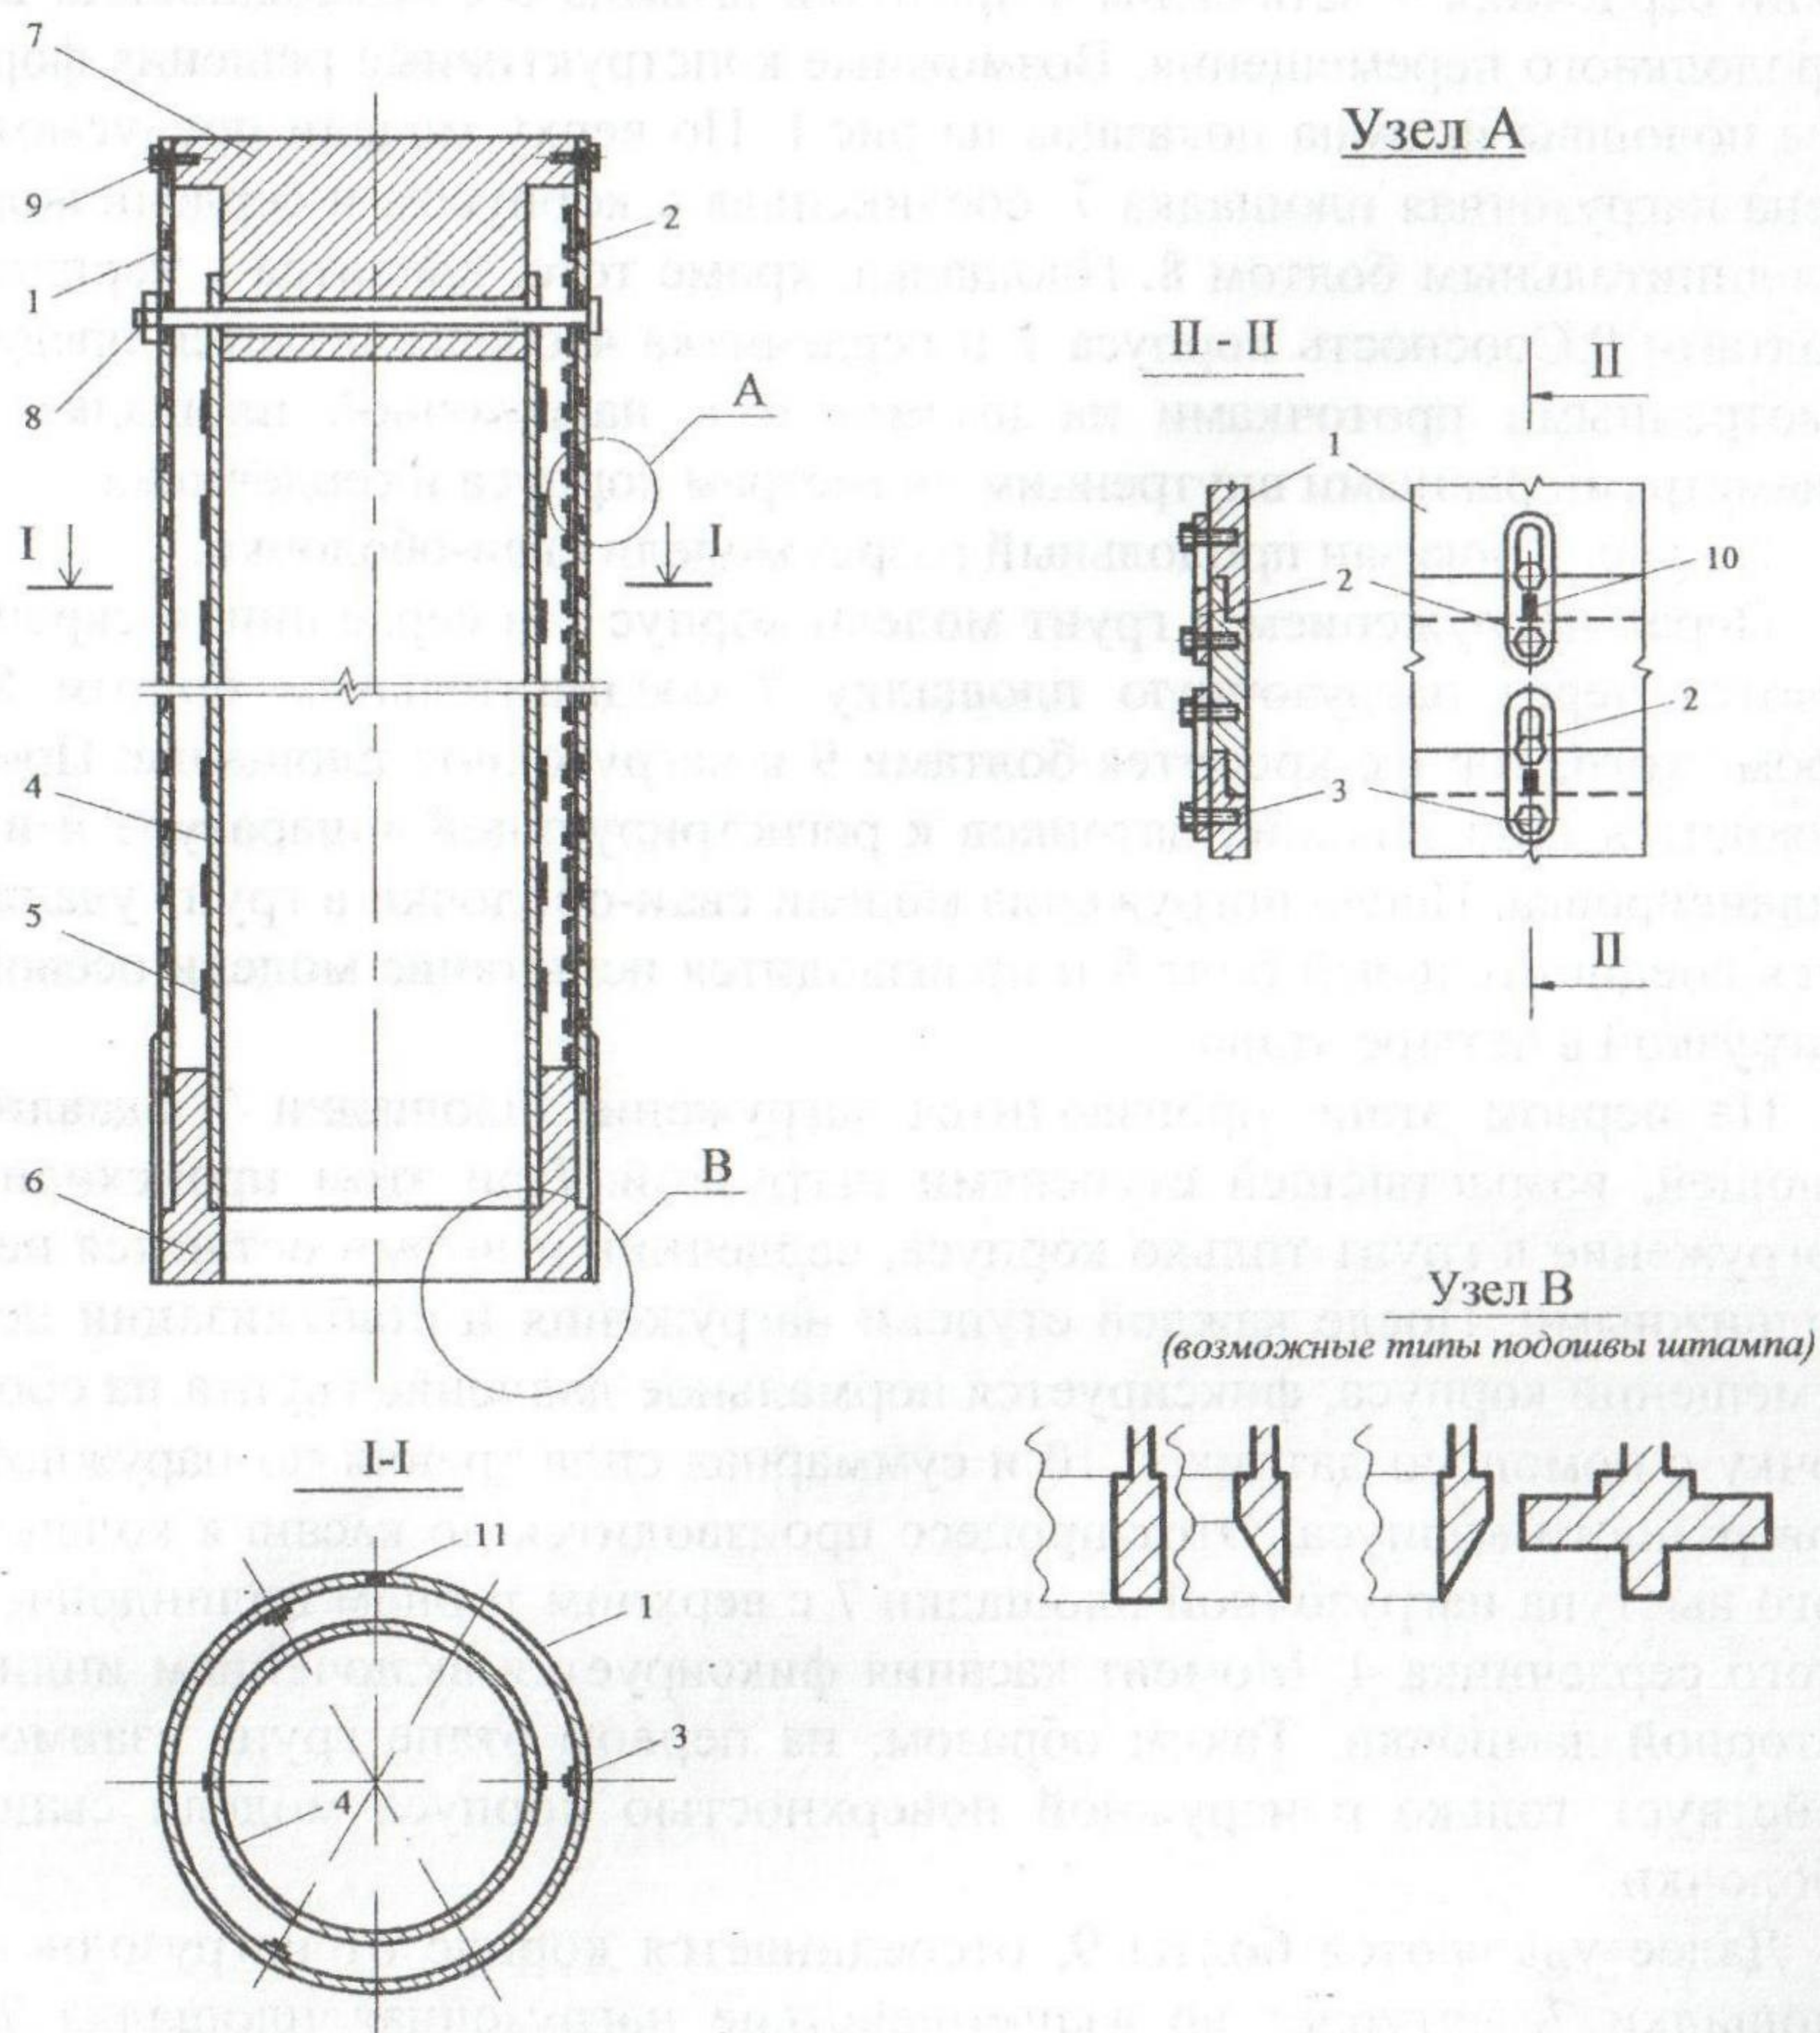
Продольный разрез модели сваи-оболочки: 1 – корпус; 2, 3 – плоские скобы и болты для их крепления; 4 – цилиндрический сердечник; 5, 10 – тензорезисторы; 6 – штамп; 7 – нагрузочная площадка; 8 – соединительный болт; 9 – болты для крепления корпуса к нагрузочной площадке; 11 – датчики давления грунта
